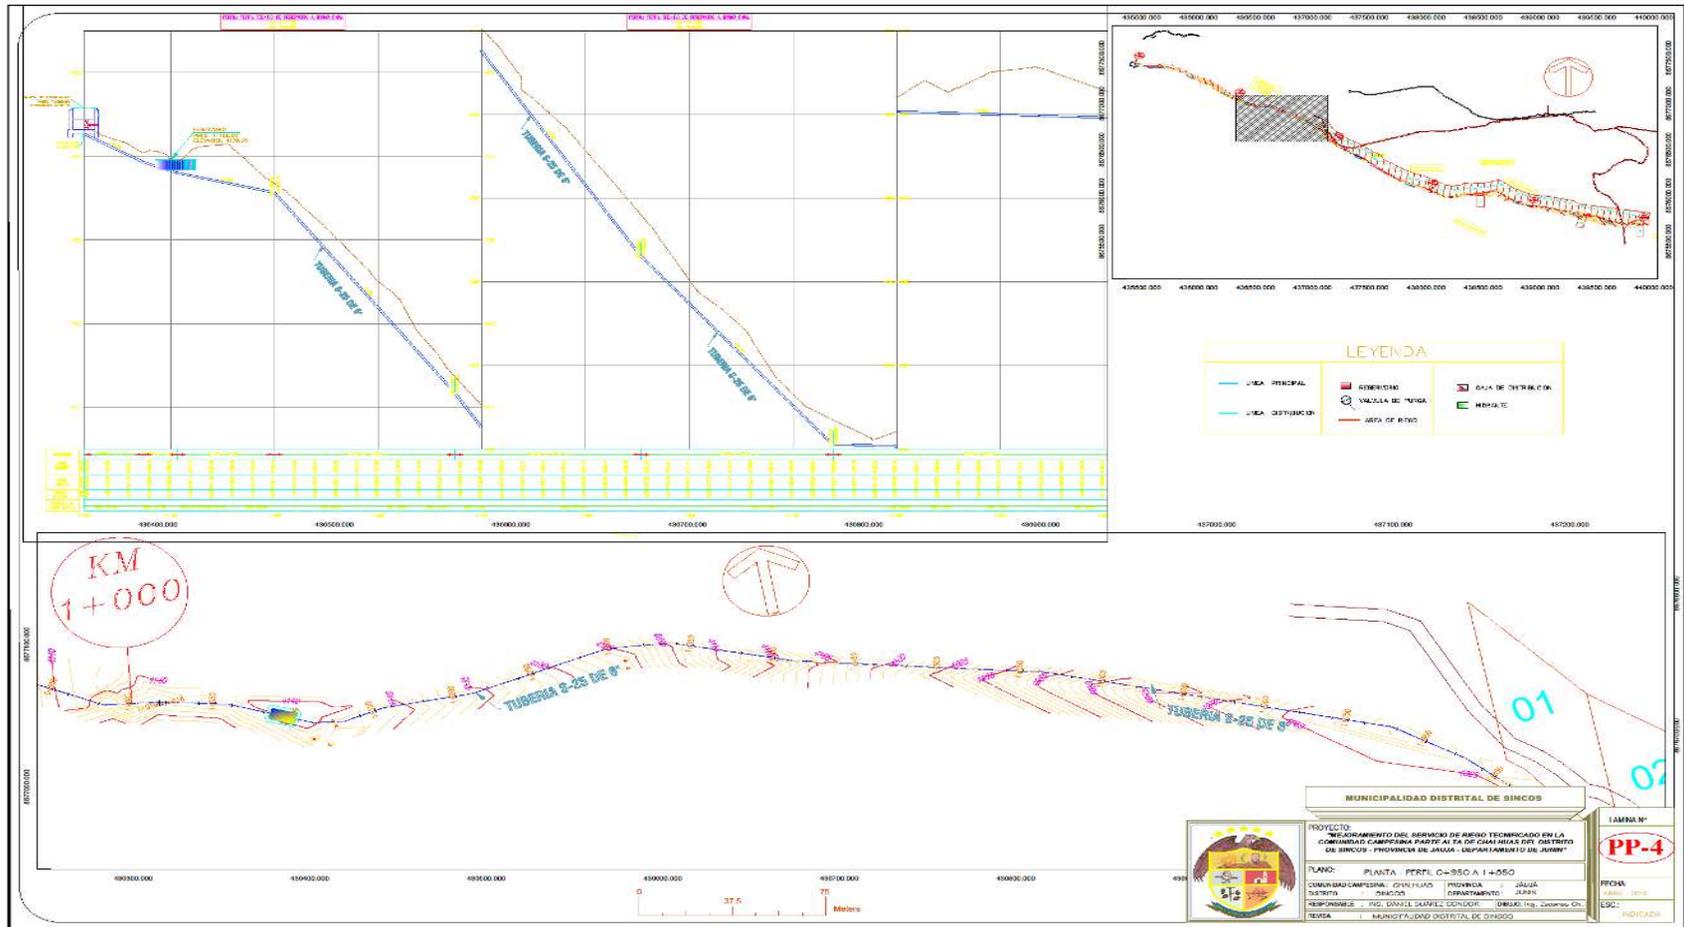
Plano de planta - perfil de canal Prog. 0+950 a 1+850.
